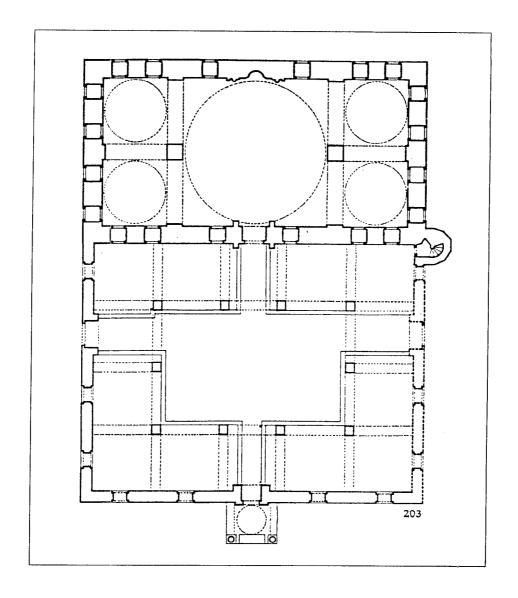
مسقط أفقي لمسجد الخان في طلاس (عن: Türkmen)
